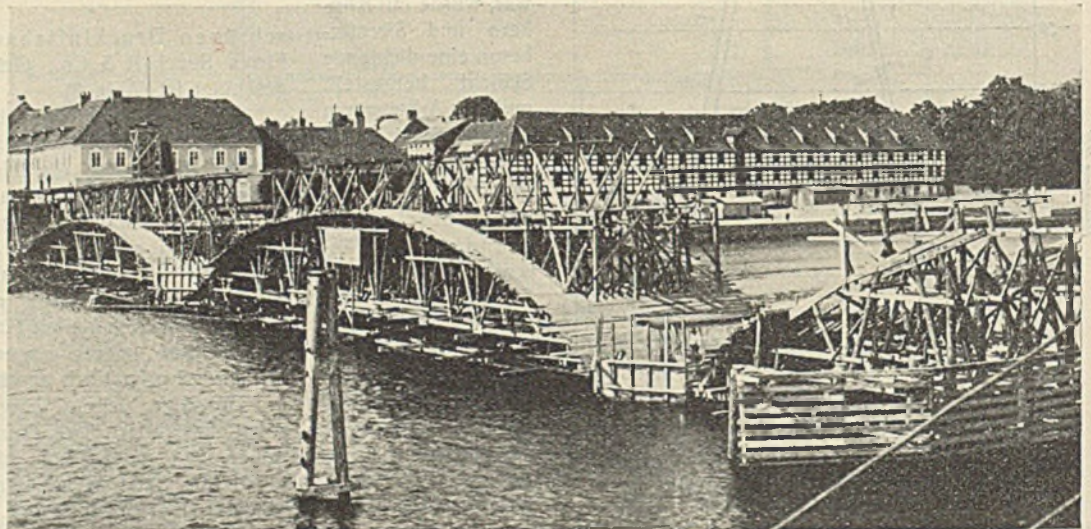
Lehrgerüst und Beförderungsbrücke im Bau.
